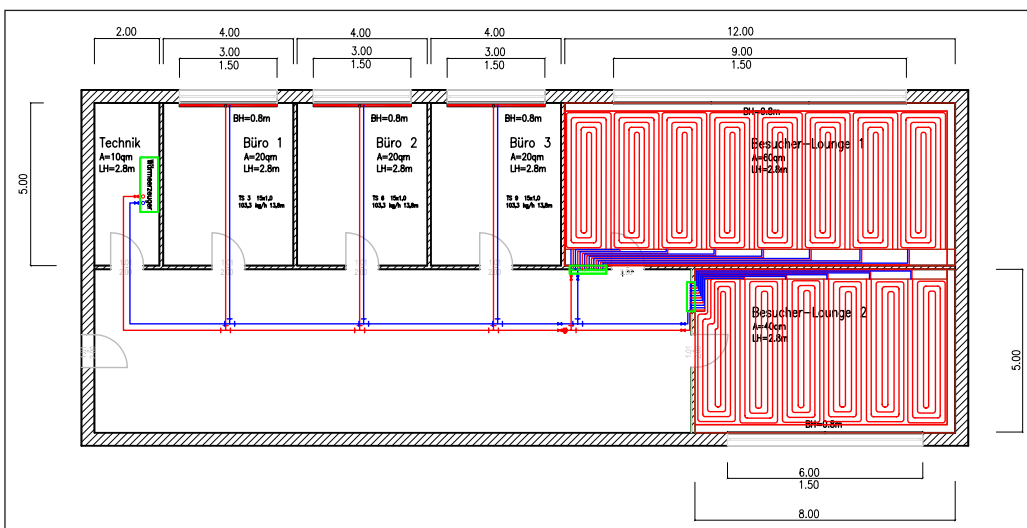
Grundriss des Bürogebäudes (Anlagenhydraulik).
